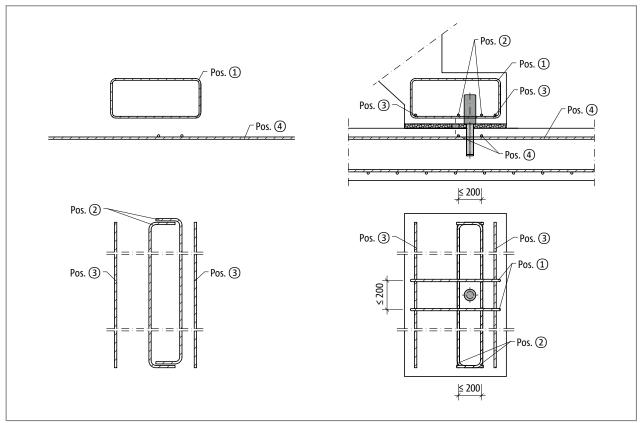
Schöck Tronsole® type D: On-site reinforcement
